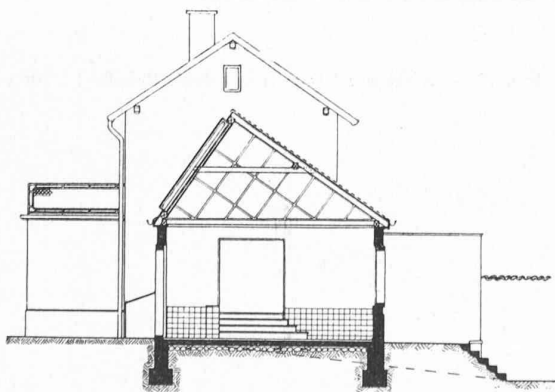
Ziegler : Coupe transversale sur l'atelier.
